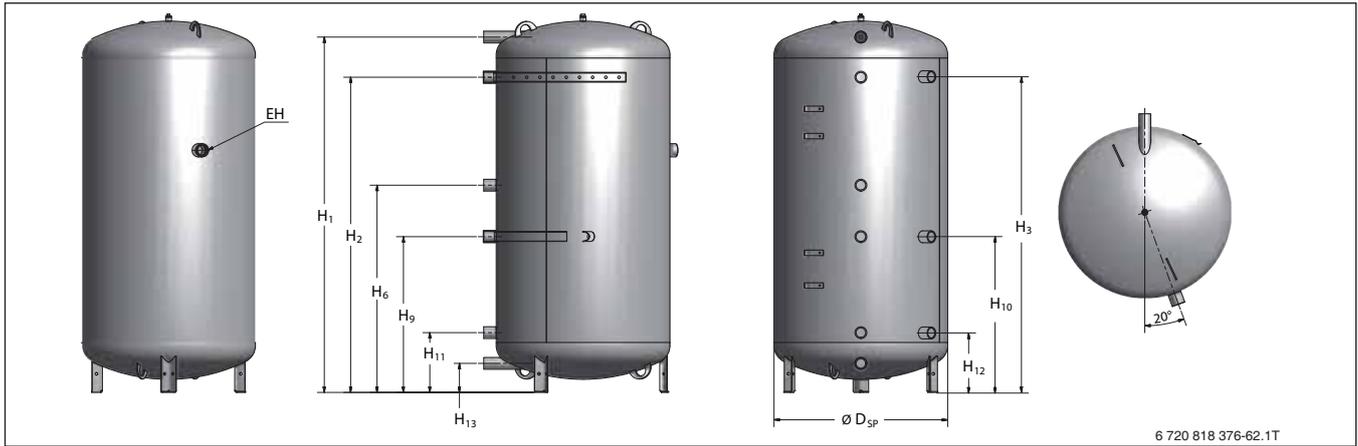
Anschlüsse mit Abmessungen PRZ500/750/1000.6 EW (Darstellung ohne Wärmedämmung)
